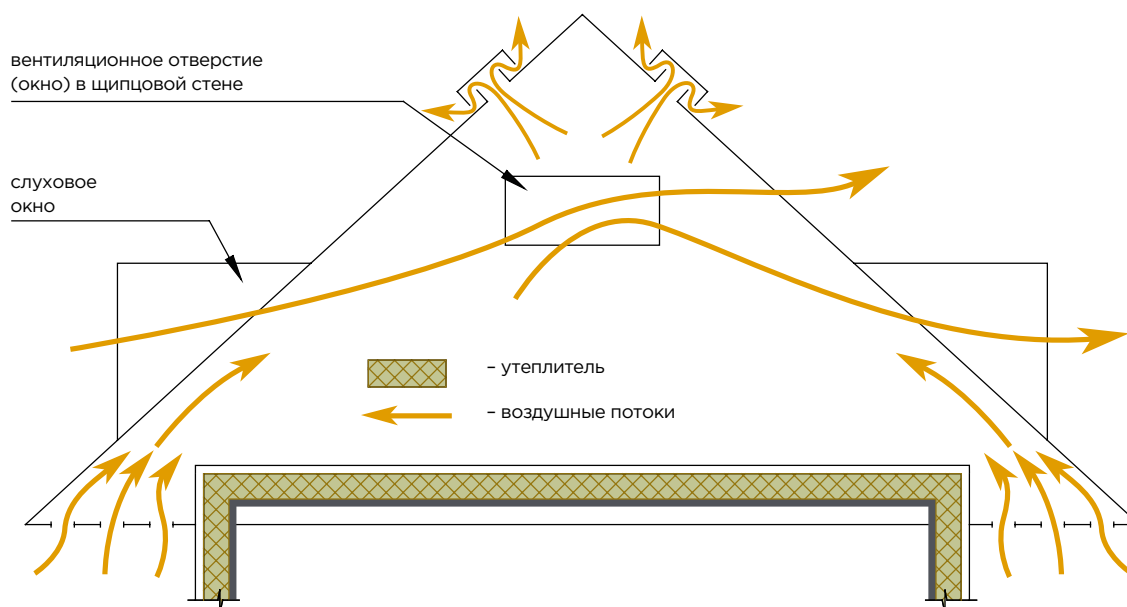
Схема утепления и вентиляции нежилого чердачного помещения
